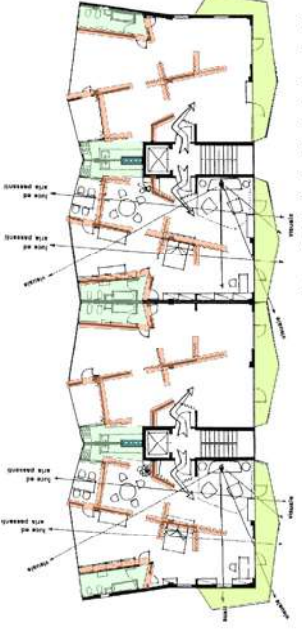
Fragmento Planta Pav. Tipo E: 1/400
